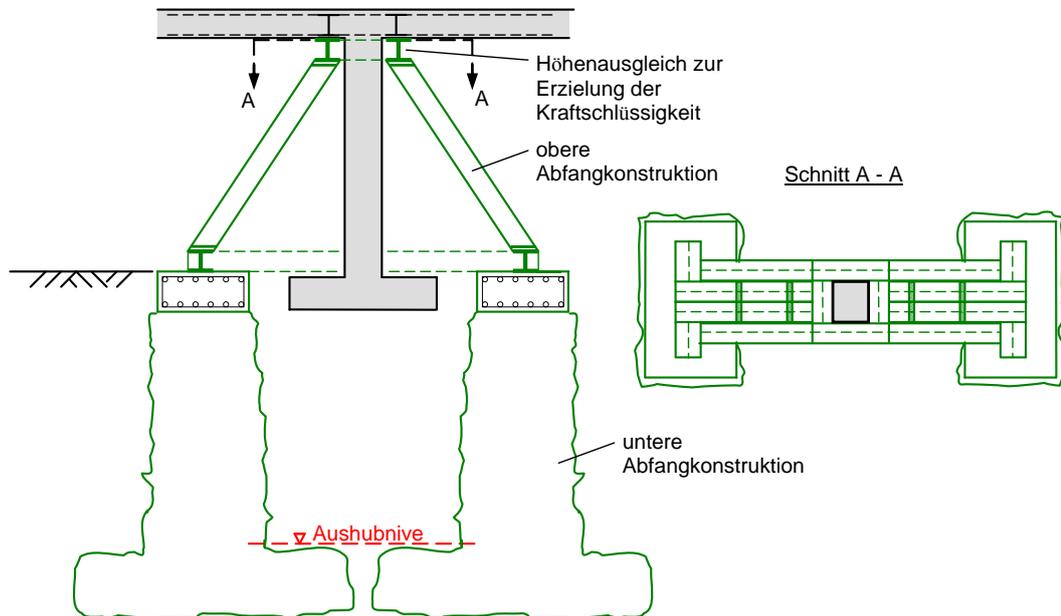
Konstruktives und Baubetriebliches System (Variante I):
